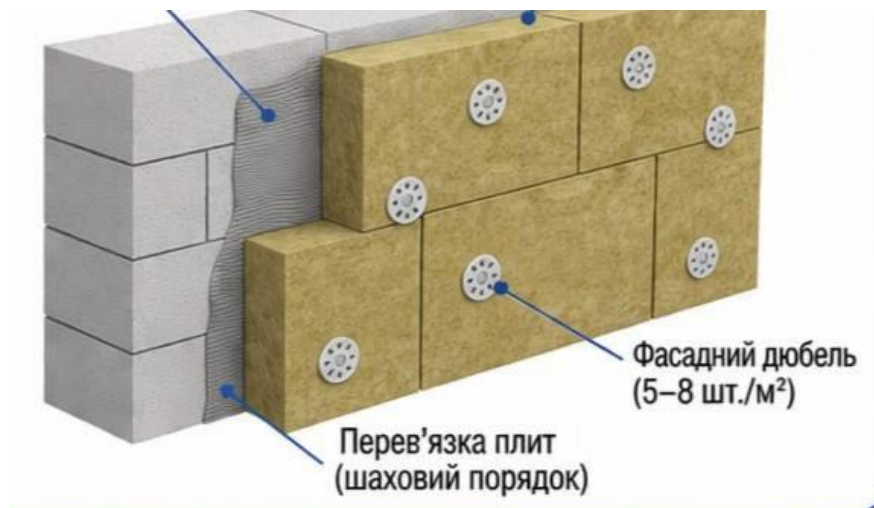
Схема кріплення мінераловатних плит
